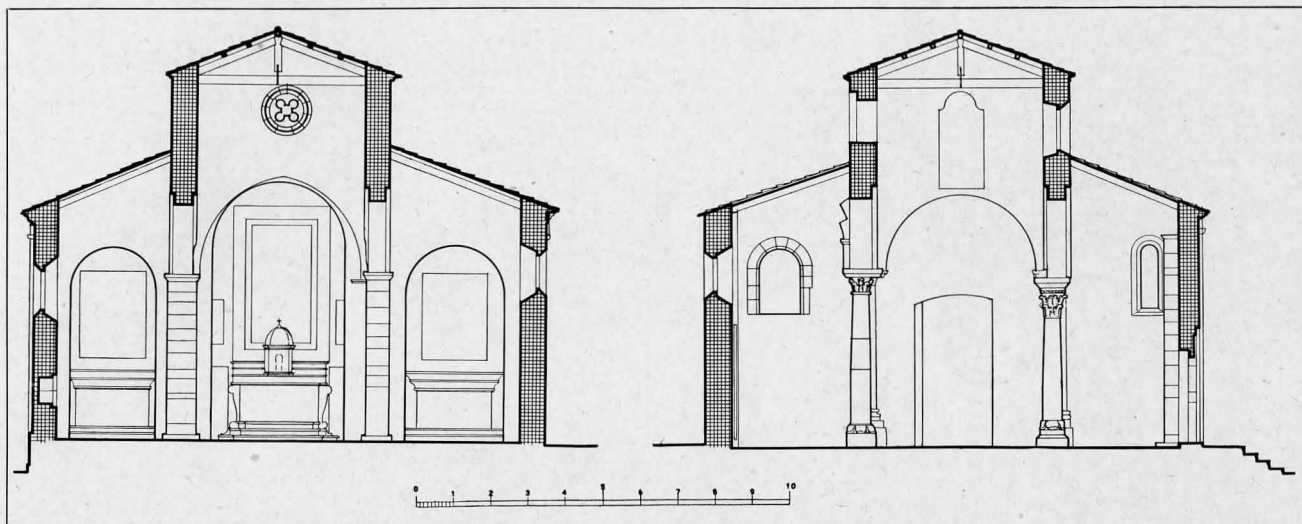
LA SEZIONE TRASVERSALE VERSO IL PRESBITERIO; LA SEZIONE TRASVERSALE VERSO LA FACCIATA
